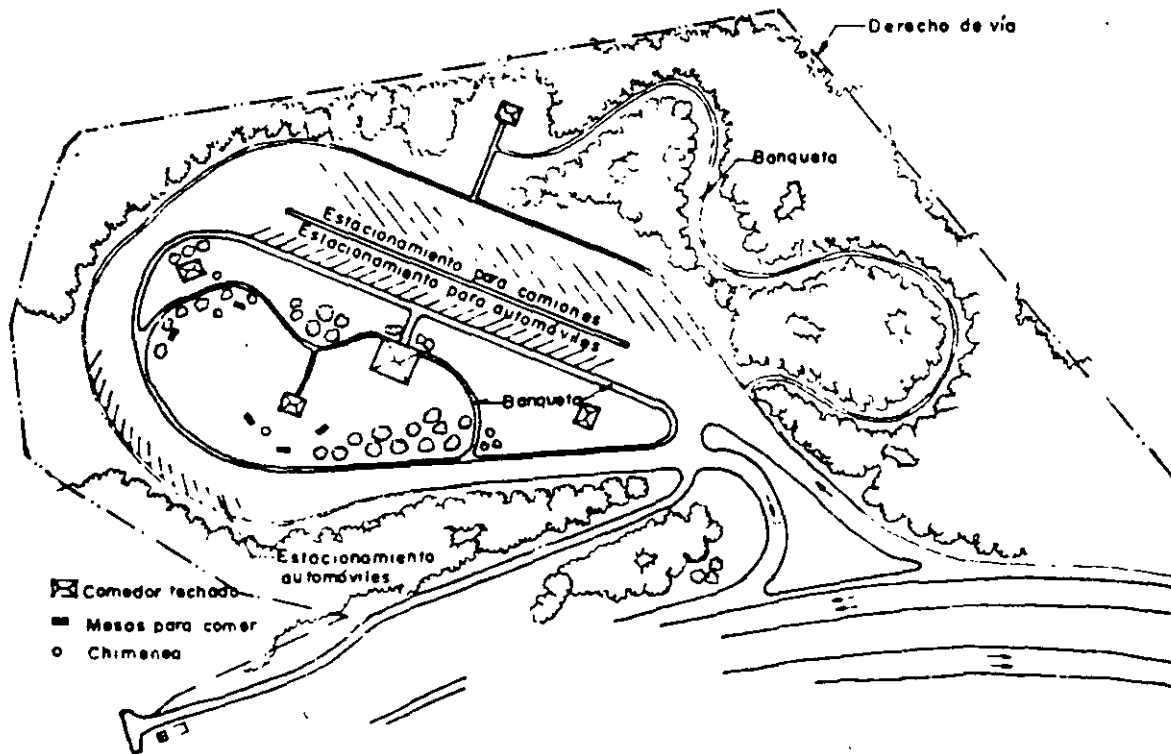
ZONA DE DESCANSO CUYA ENTRADA ESTA PROXIMA A LA SALIDA
